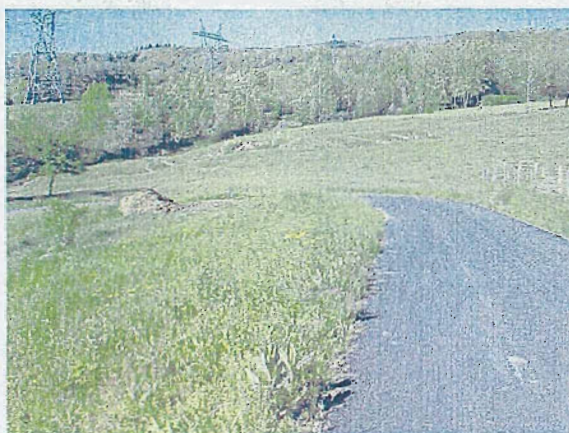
Virage du Mollard ayant fait l'objet de travaux et vue sur un secteur mouvementé en arrière plan.
